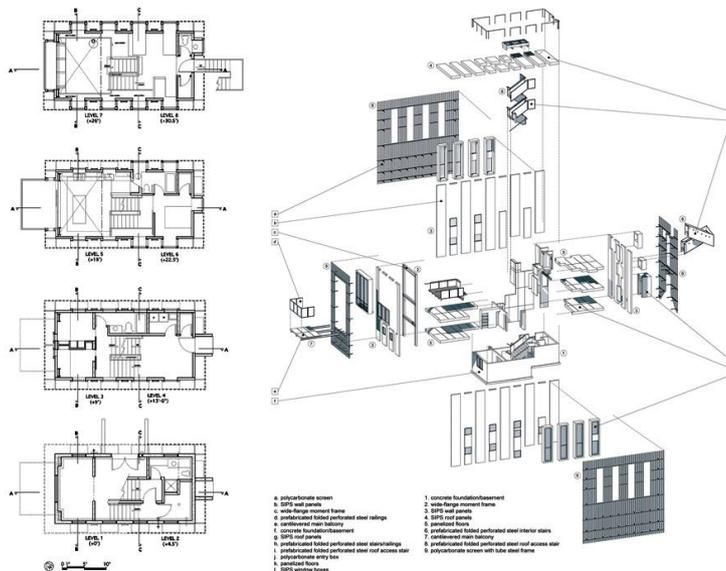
Explosionszeichnung – Wochenendhaus¹⁵⁷
